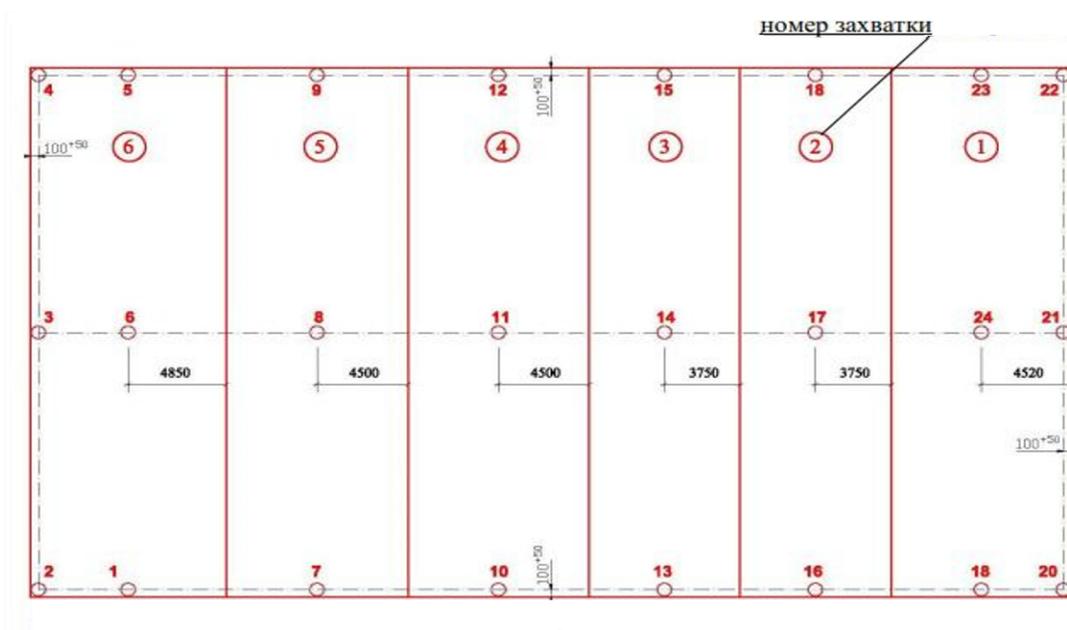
Схема расположения контрольных температурных трубок на захватках бетонирования фундаментной плиты
